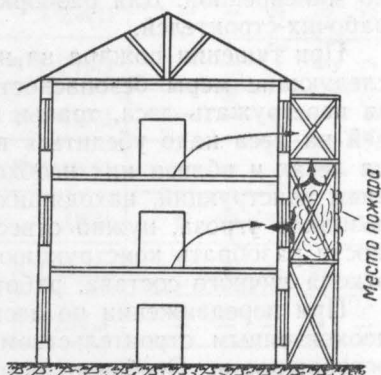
Схема подачи стволов при пожаре наружных лесов.
